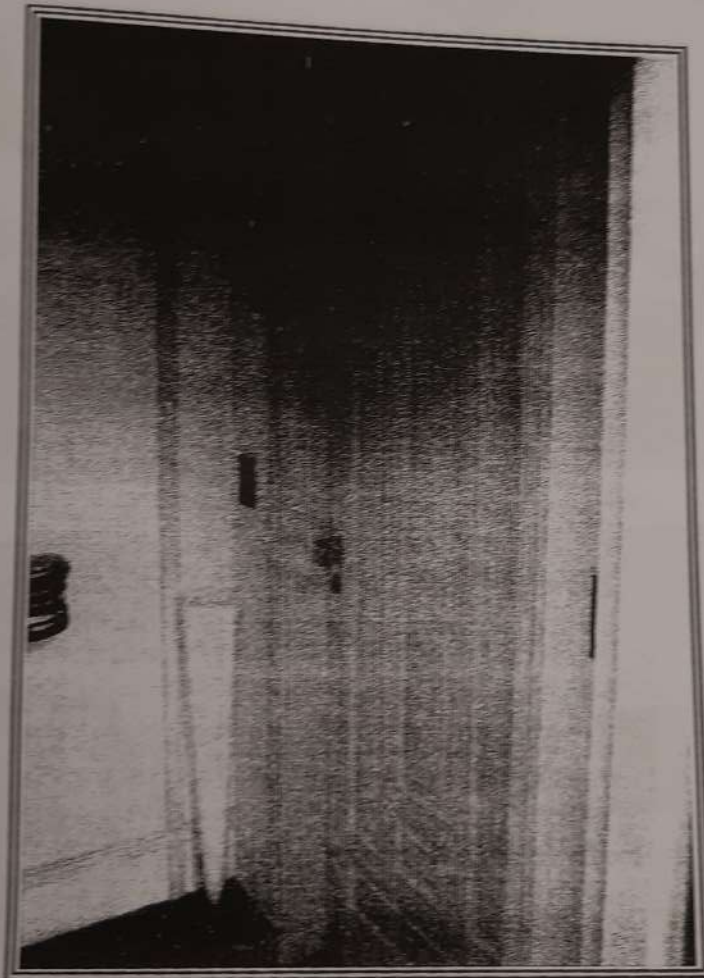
Vista do hall de entrada do imóvel avaliando
